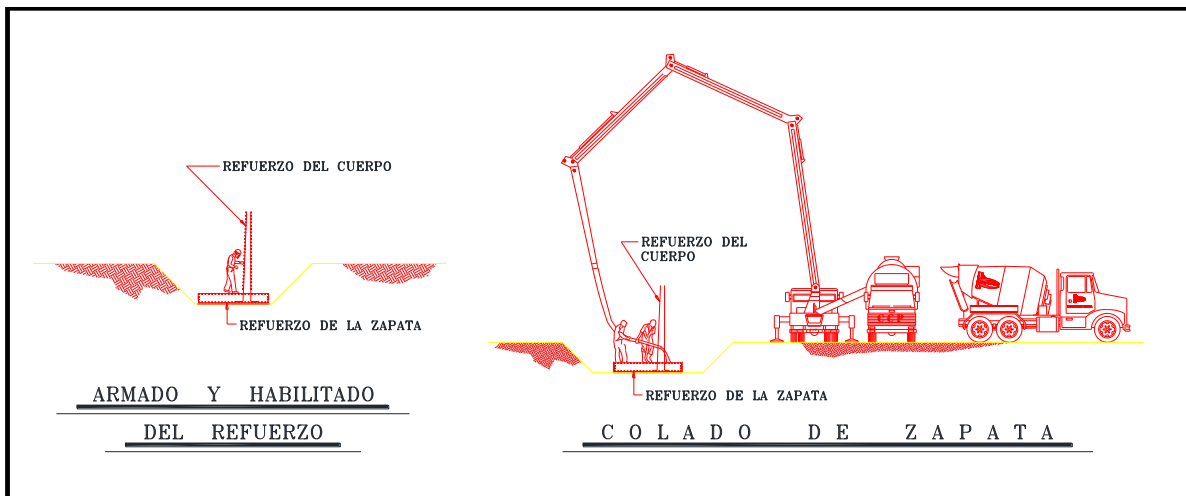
Armado, habilitado de refuerzo y colado de zapata.
